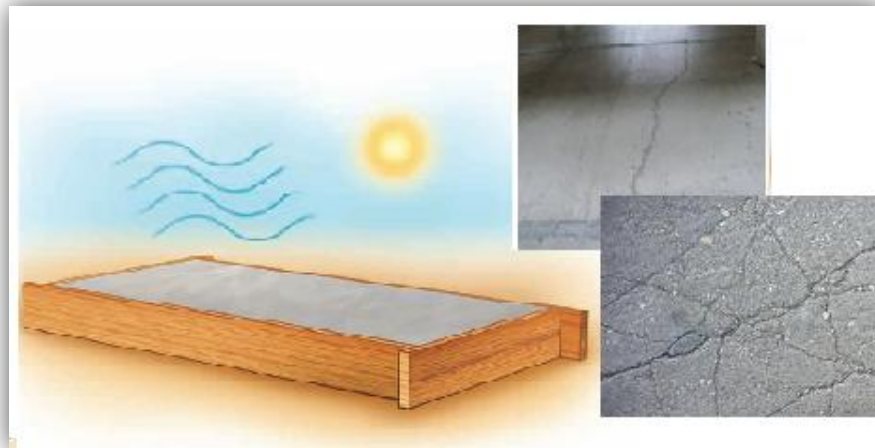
Las grietas por contracción plástica aparecen en la superficie del concreto a las pocas horas del colado, a veces muy pronto después y frecuentemente antes del allanado. A menudo no se notan hasta el siguiente día, pues se desarrollan luego de que los trabajadores han dejado la obra. Raramente perjudican la resistencia del concreto, pero de modo común forman un patrón, como las ramas de un árbol.
